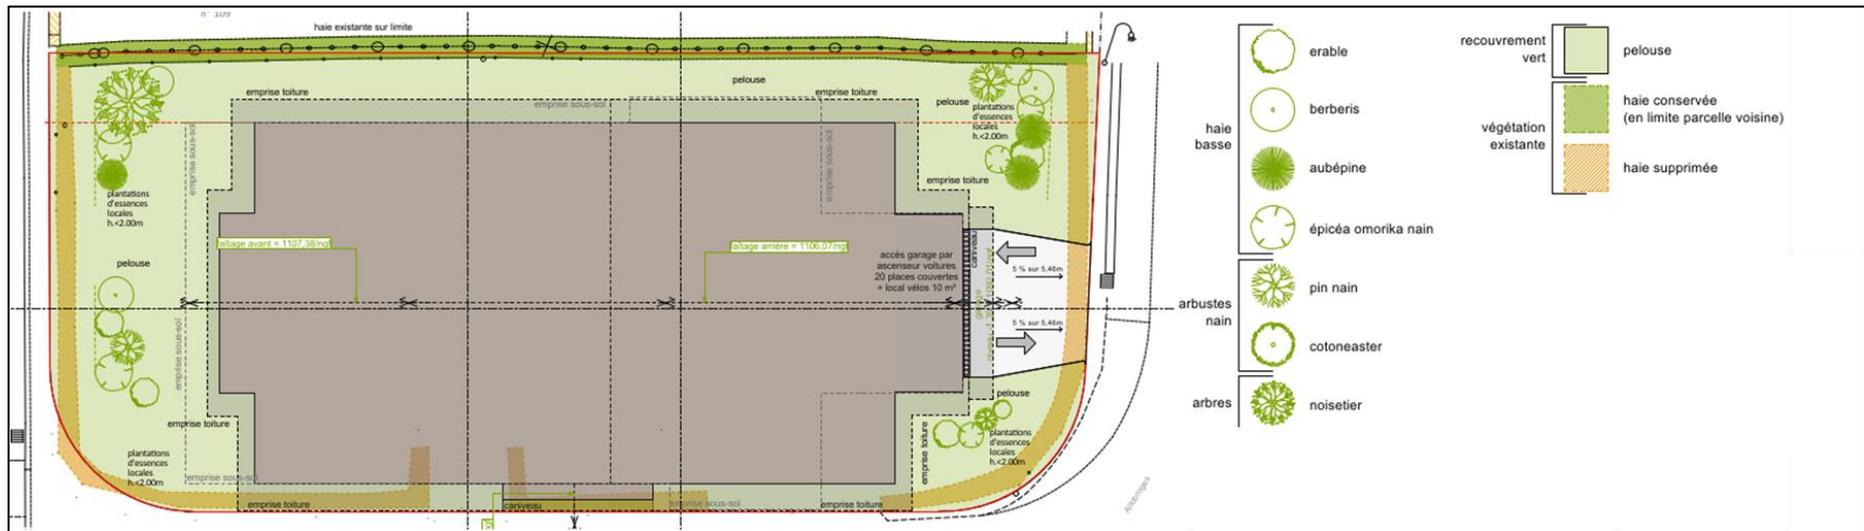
Plan paysager (source : Dossier PC haag&baquet)
